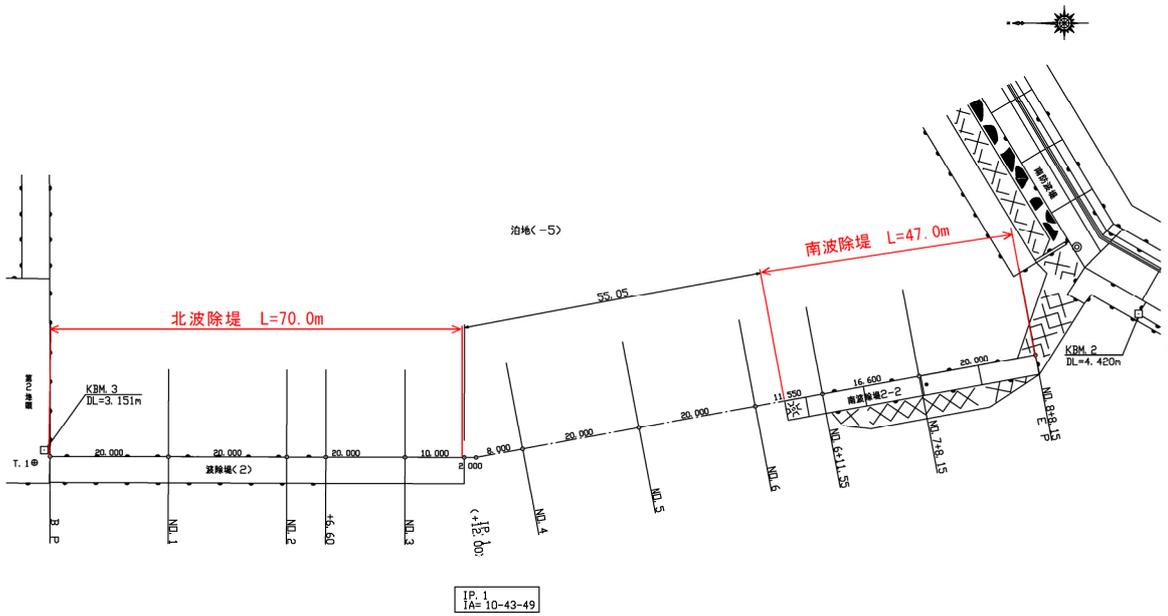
119 No.5 大洗港区_北波除堤の平面図 (被災前)
